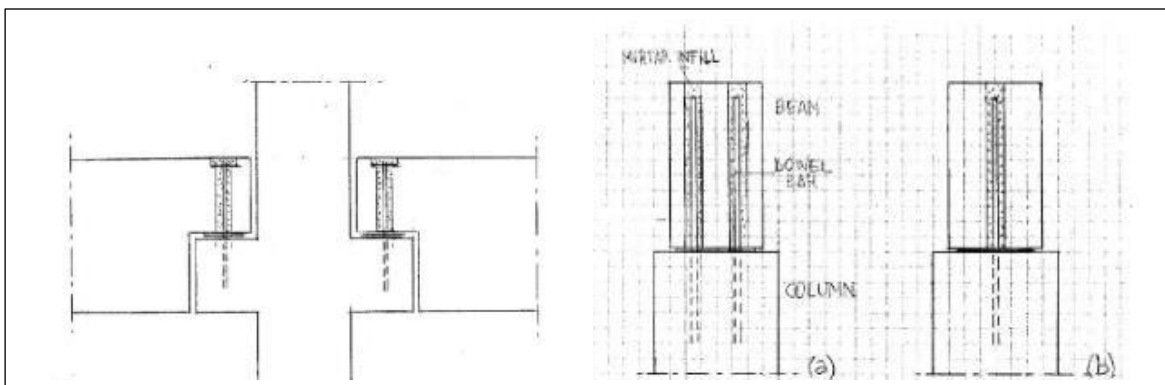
Principe de la connexion poutre-poteau par goujons dans les structures préfabriquées [35].
